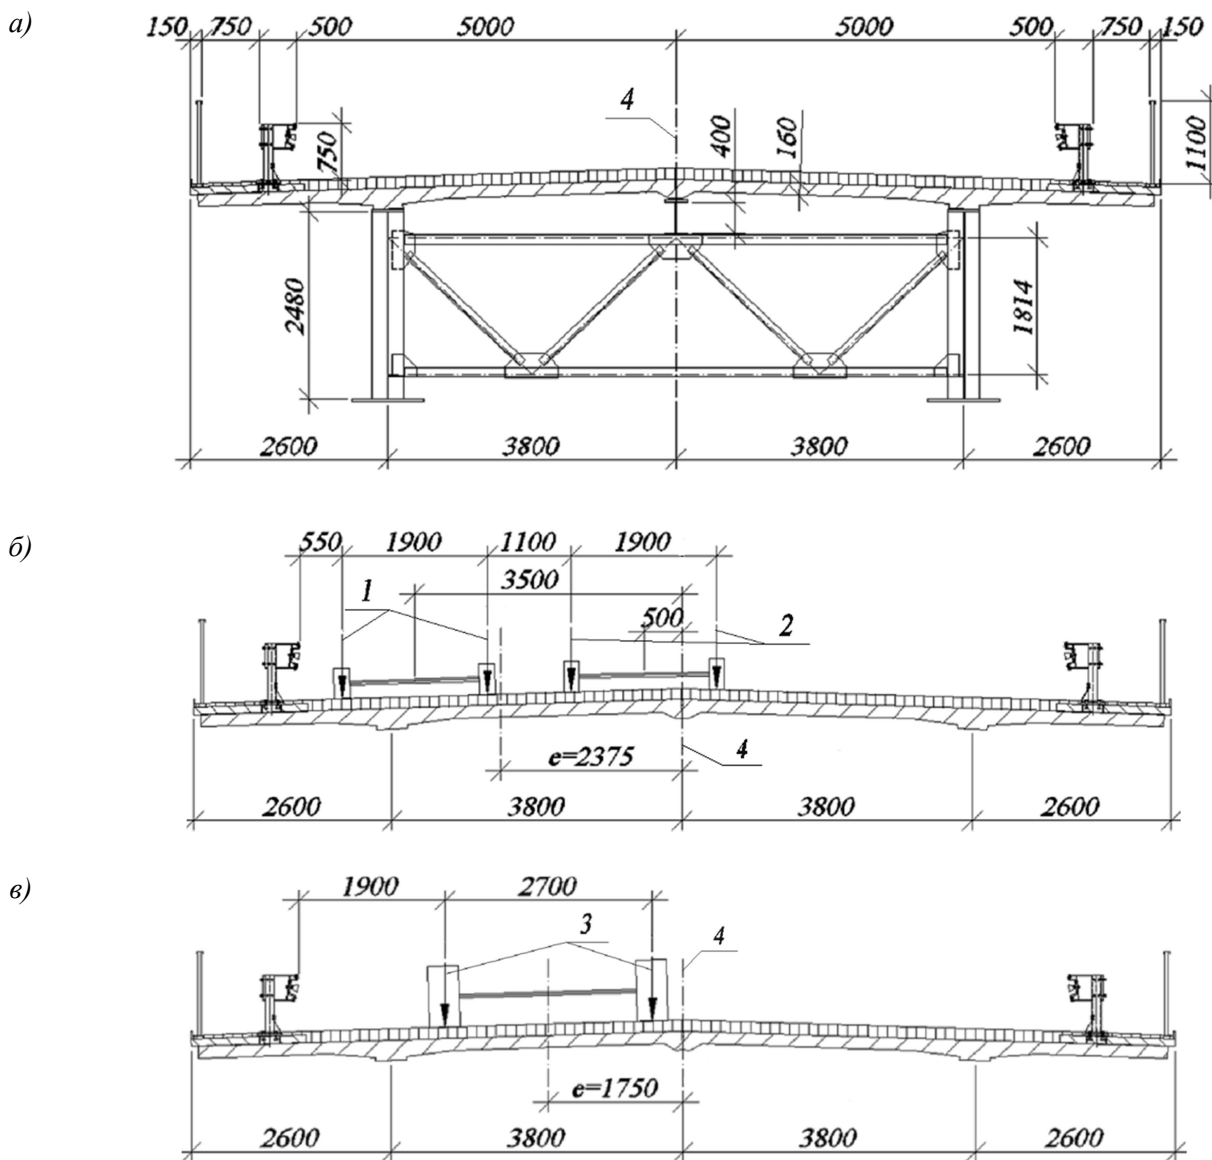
Сталежелезобетонное разрезное пролетное строение:
